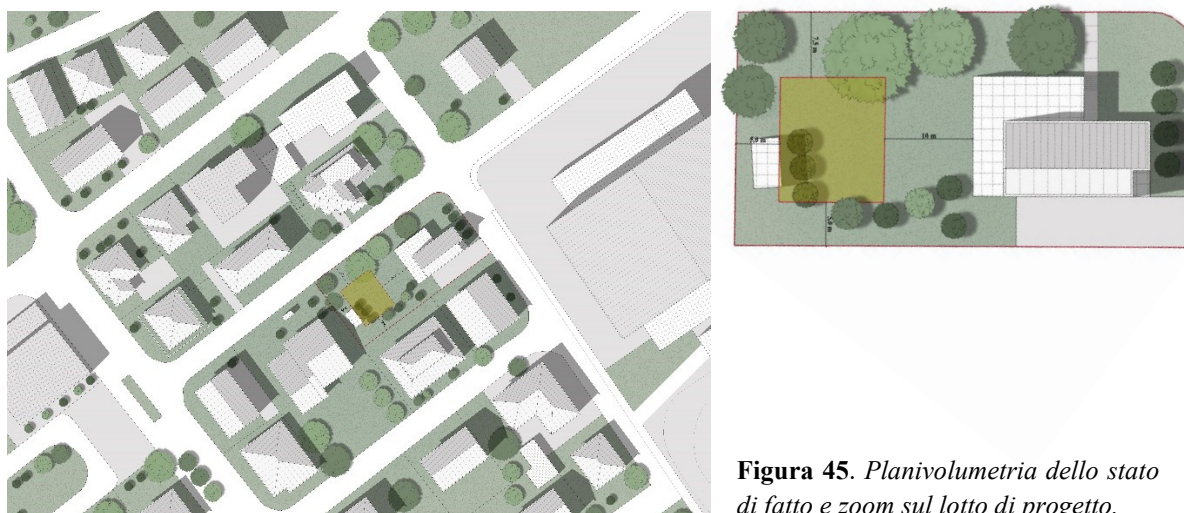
Planivolumetria dello stato di fatto e zoom sul lotto di progetto.
